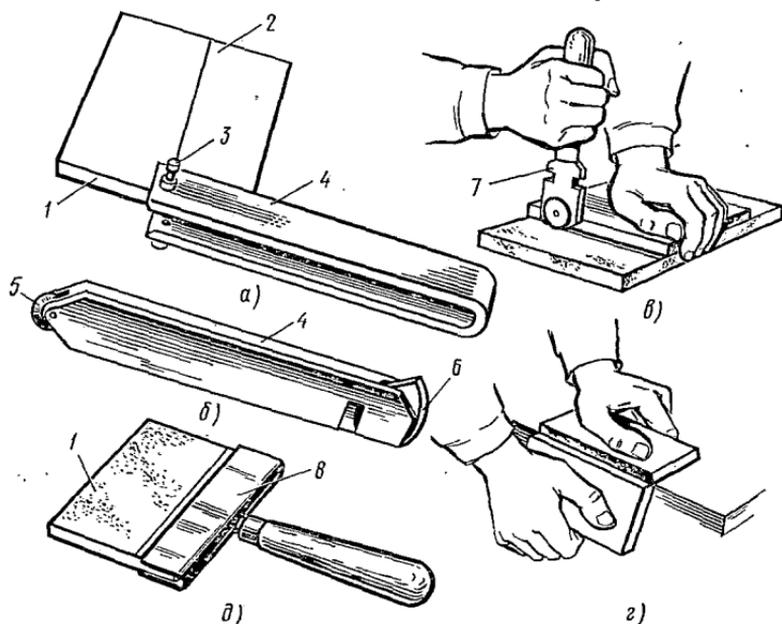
Резка плиток с помощью инструментов и приспособлений: а — нанесение разметочной риски рейсмусом, б — резец, в — резка стеклорезом, г — откалывание надрезанной части, д — отламывание плитколомом: 1 — плитка, 2 — риска, 3 — резец, 4 — корпус, 5 — ролик из твердого сплава, 6 — нож, 7 — стеклорез, 8 — плитколом
